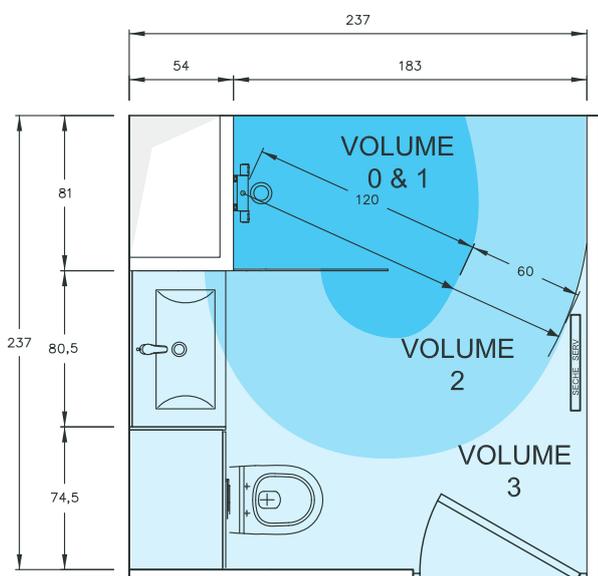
/ Plan de câblage salle de bain MODUL'EAU
